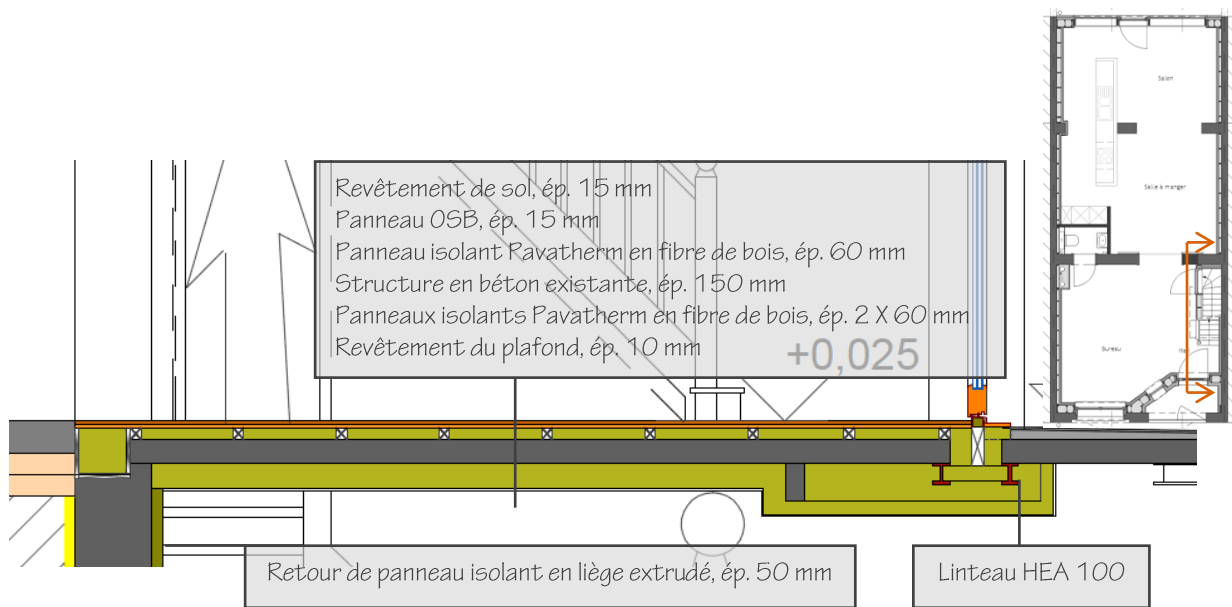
Détail de la dalle en béton coupée, mesures en [mm] (Source : Alexandre O., 2011)
